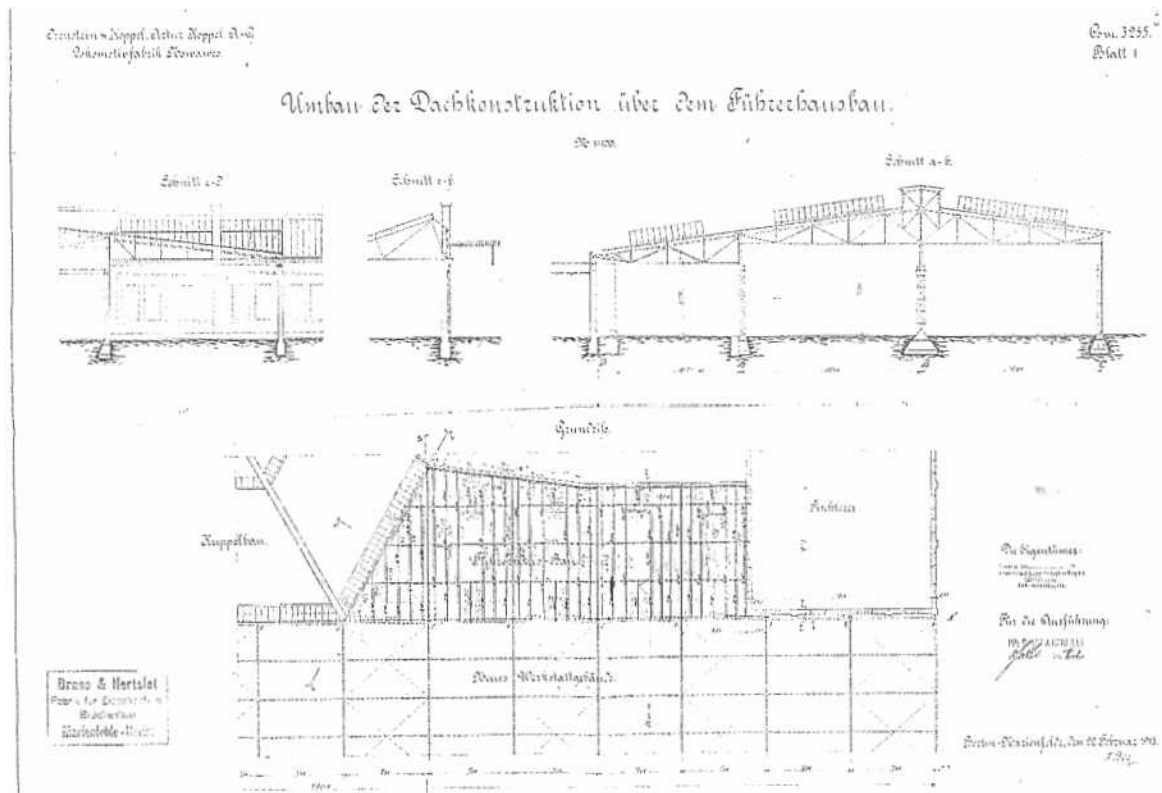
„Orenstein&Koppel, Artur Koppel A.-G. Lokomotivfabrik Nowawes. Umbau der Dachkonstruktion über dem Führerhausbau.“ Grundriß Schnitte a-b, c-d, e-f 1. u.: Stempel (rot), Ausführung: Brass & Hertelot; Fabrik für Eisenhoch- und Brückenbau, Marienfelde-Berlin, 1913, M 1 : 100, 97,1 x 64, 9 cm (Blattgröße). Lichtpause, teilweise aquarelliert, nachträgliche Maßeintragungen, alte Inv.-Nr.: Com. 3255. Blatt 1; Sammlung Schöning.
